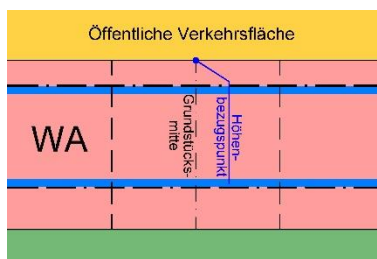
Höhenbezugspunkt Einzelhausbebauung
